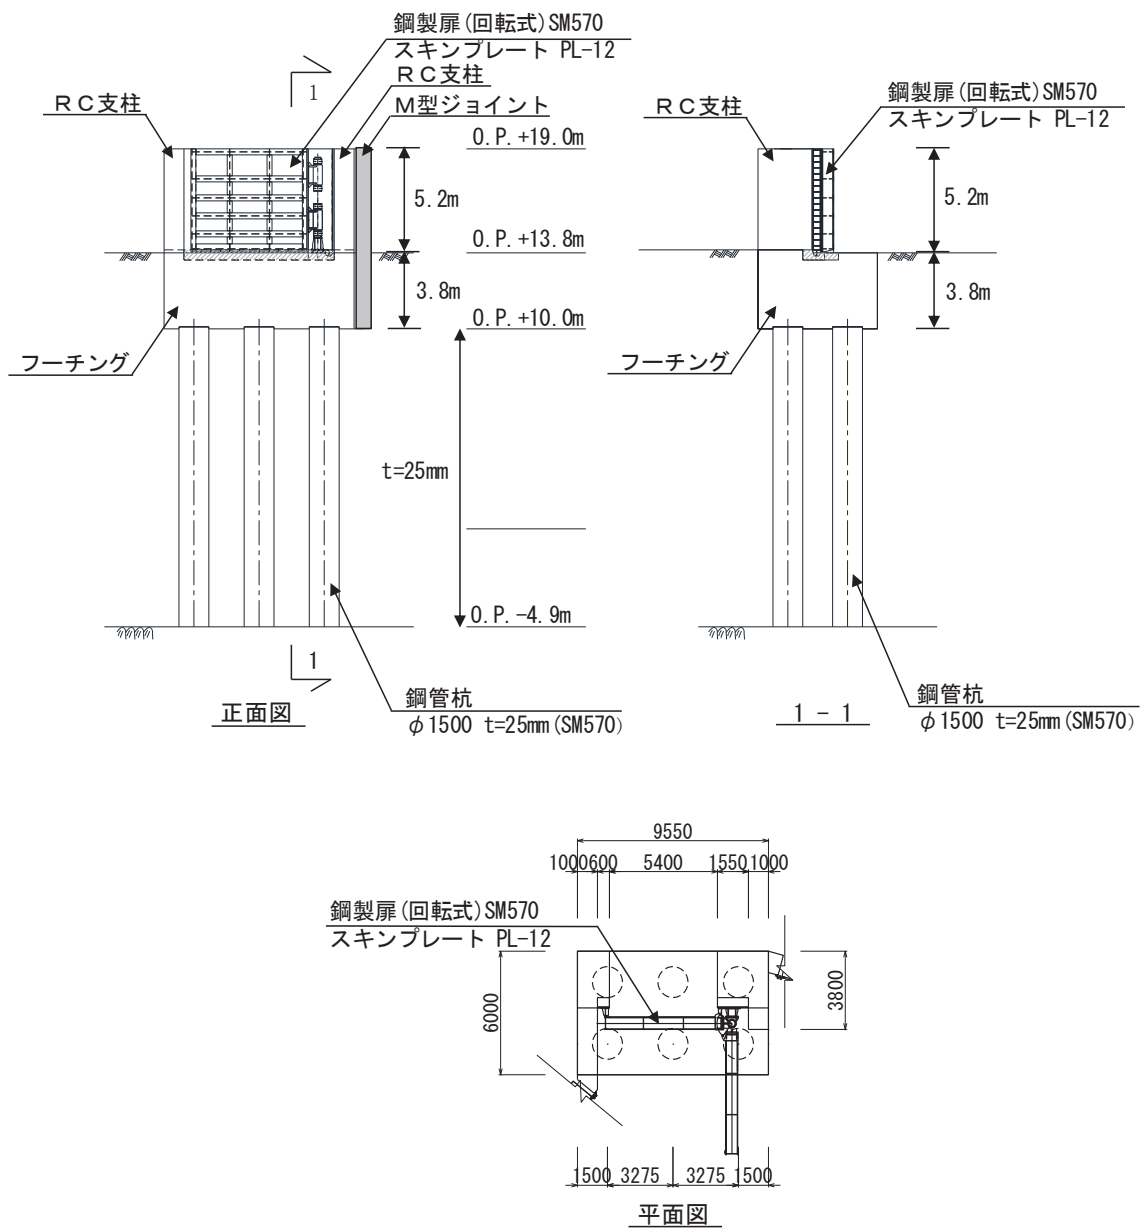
(1) 鋼製扉 2 の構造図 (正面図及び断面図, 平面図)
